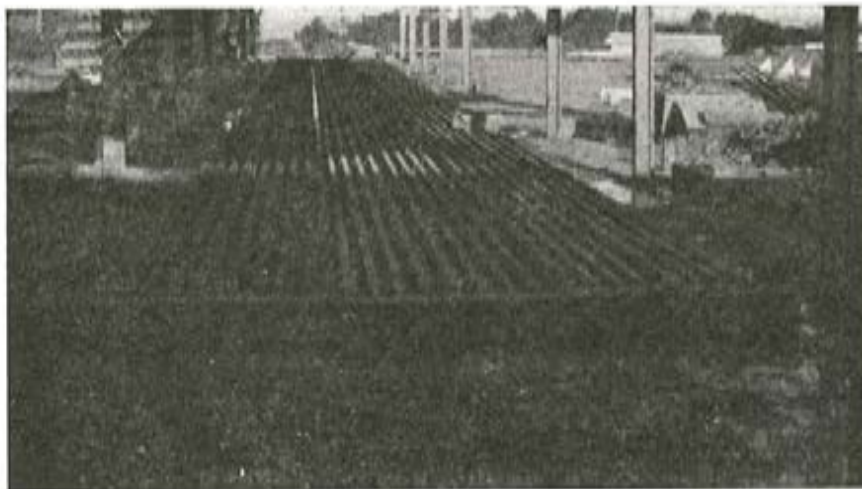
Banco triple de fabricación de 24 hileras de viguetas de 100 m l de longitud.
